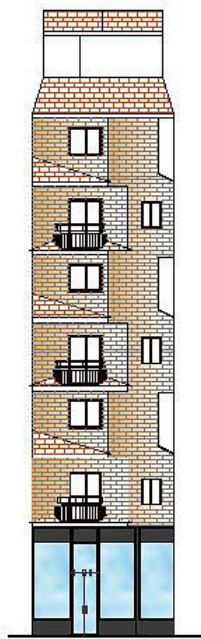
Chaflán - Fachada Suroeste, F2 [Anexo II. Planos]
